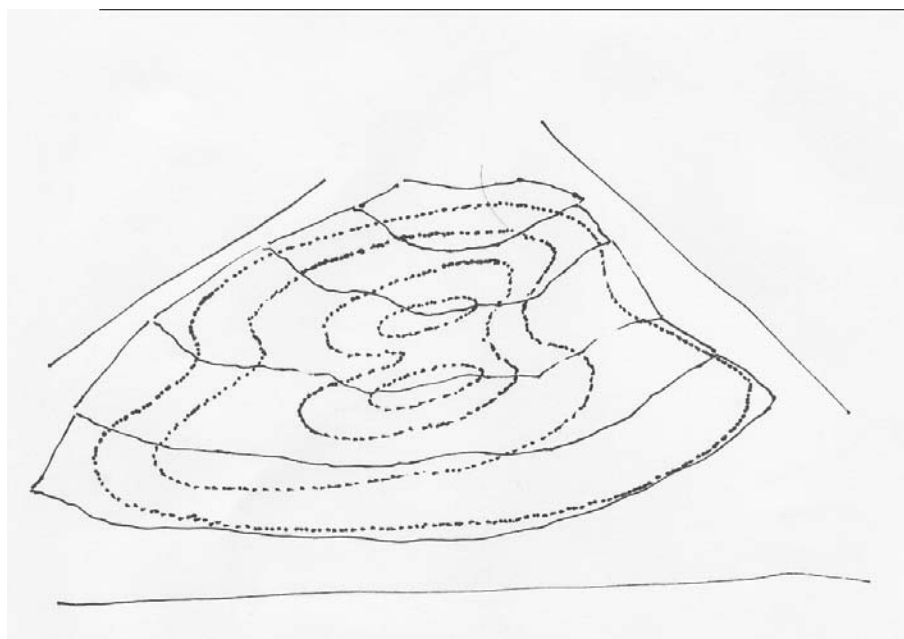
Nella seconda fase un rotolo di rete in ferro zincato a maglie di circa 5 cm viene steso sul fondo, a strisce contigue, ben adagiate e successivamente legate alle strisce vicine. Se necessario possono venire realizzati ancoraggi al substrato utilizzando pezzi di filo di ferro di 4.5 mm piegati ad U e infissi a fermare le maglie al pietrame di fondo.
